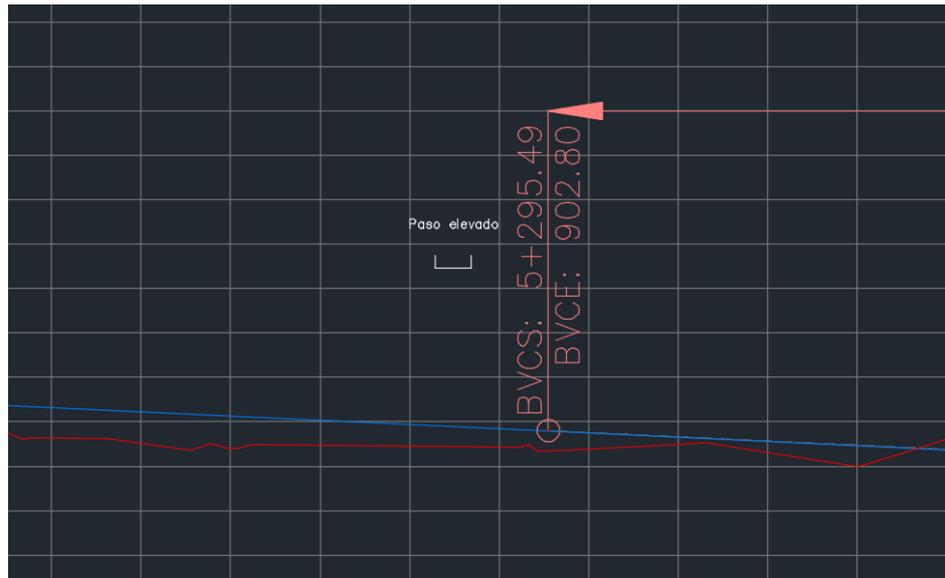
Aumento de cota bajo paso elevado en P.K. 5+344 por modificación trazado en alzado
